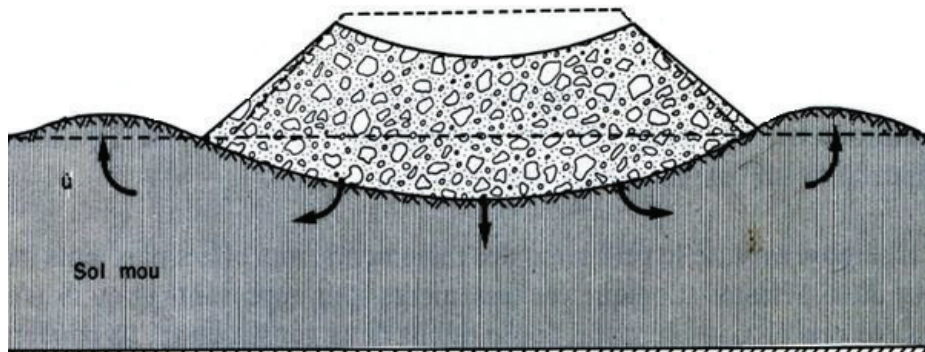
Schéma de rupture par poinçonnement d'un remblai sur une couche molle
